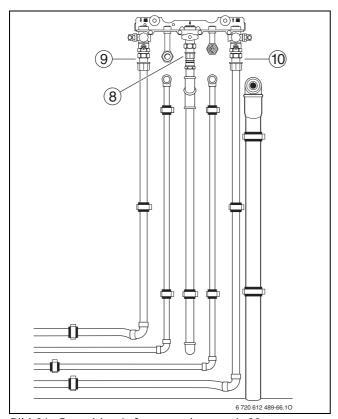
Bauseitige Aufputzverrohrung mit 60 mm Wandabstand
